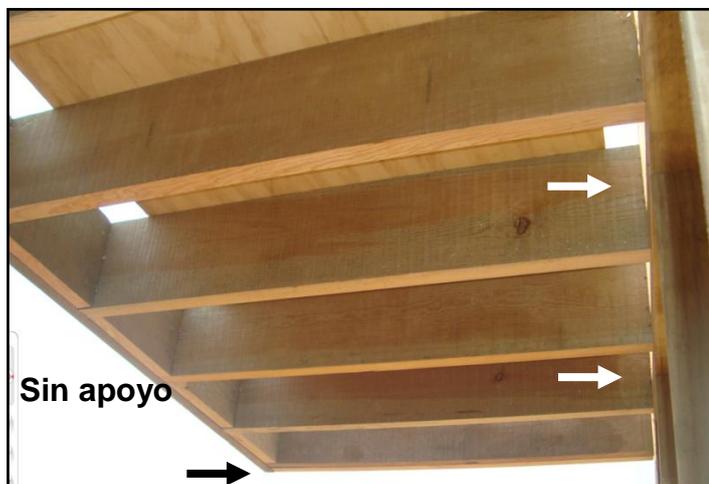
Incorrecta unión y clavado de las viguetas sin soporte en ambos lados; riesgo al colapso de la estructura.
